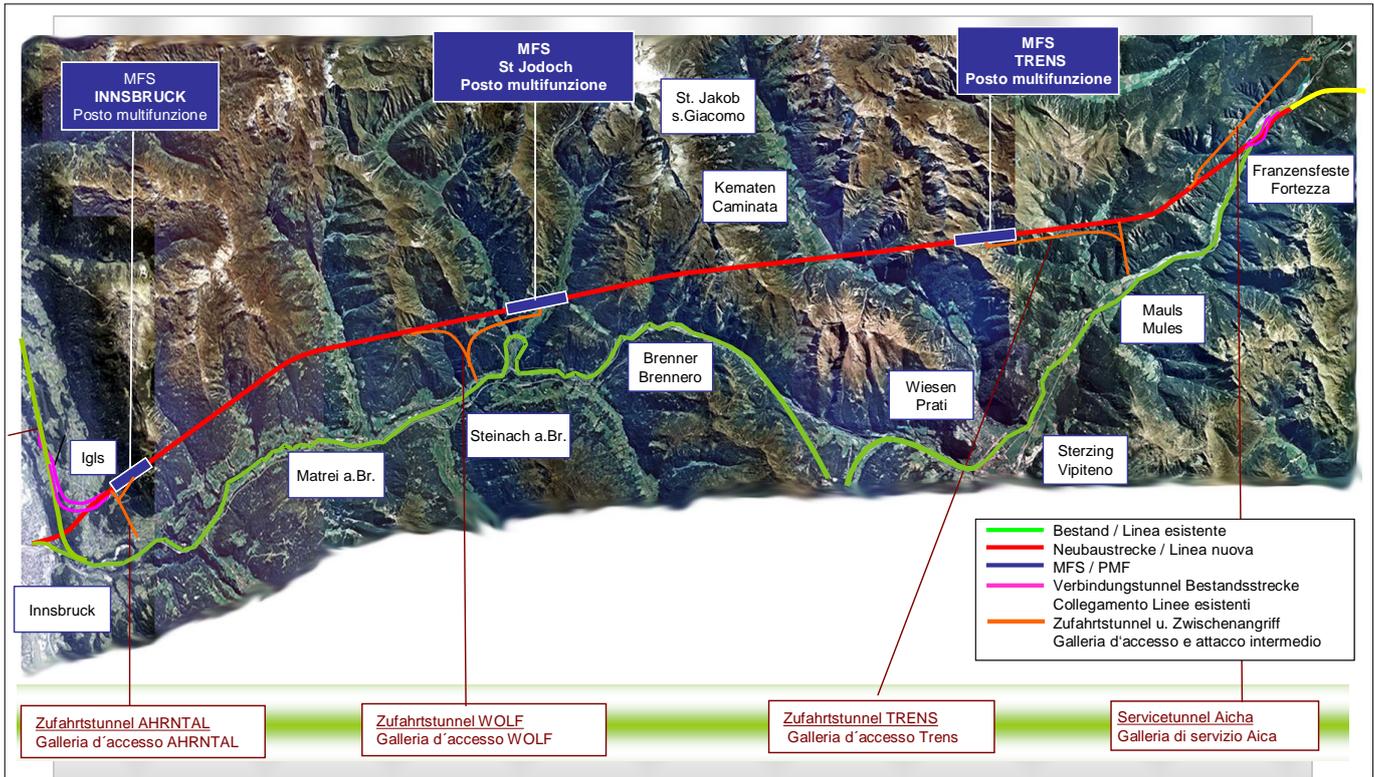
Übersichtslageplan Brenner Basistunnel
